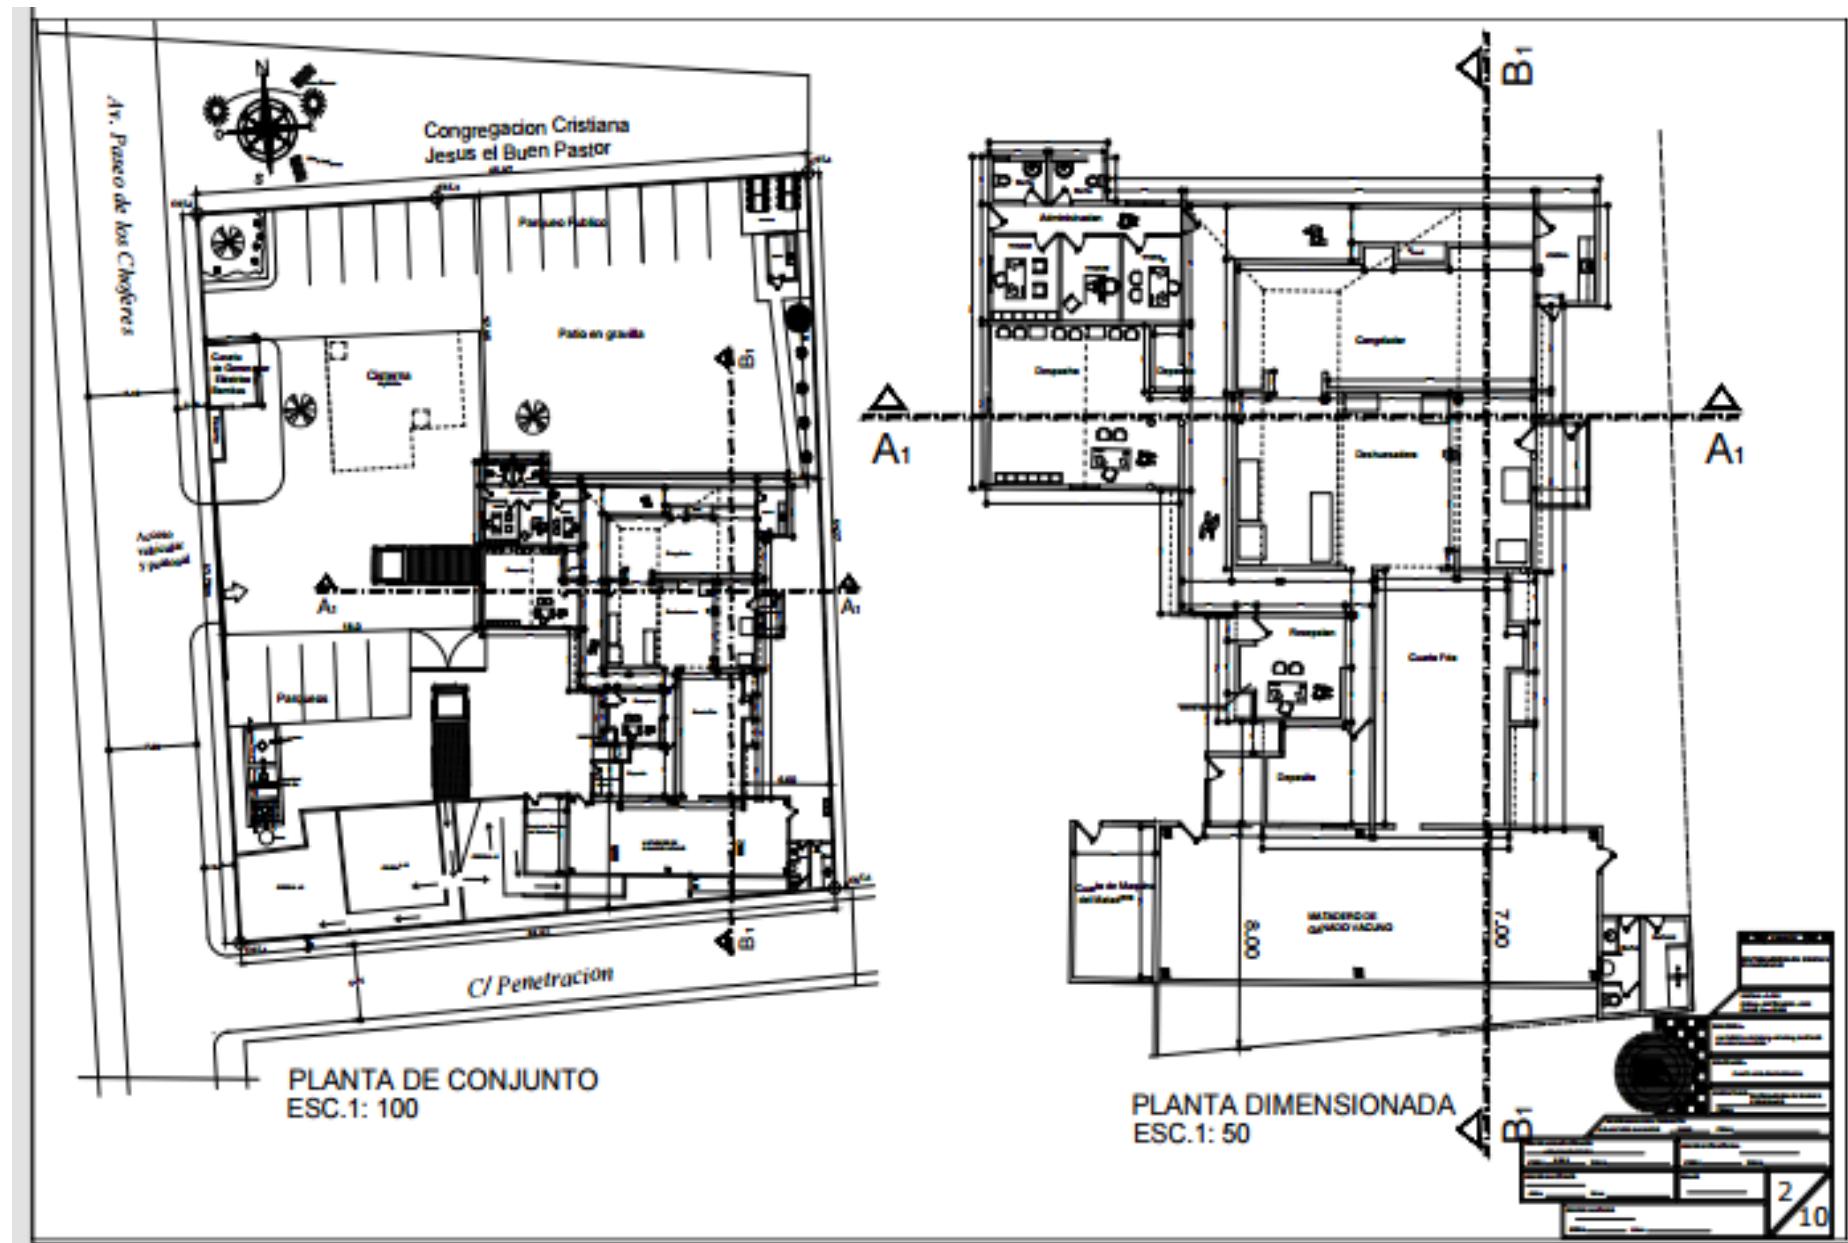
Planta de conjunto y dimensionada. (Ver anexo no. 2)
